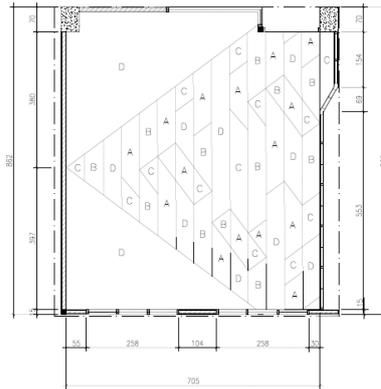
Layout Furnitur Ruang Terpilih 1
